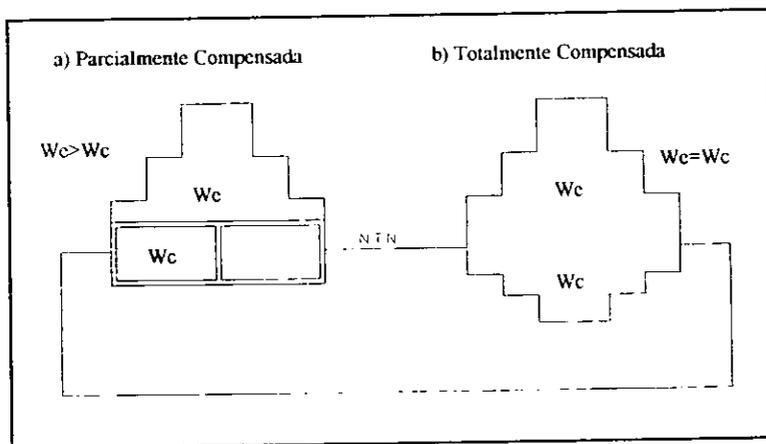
CIMENTACIONES COMPENSADAS.
